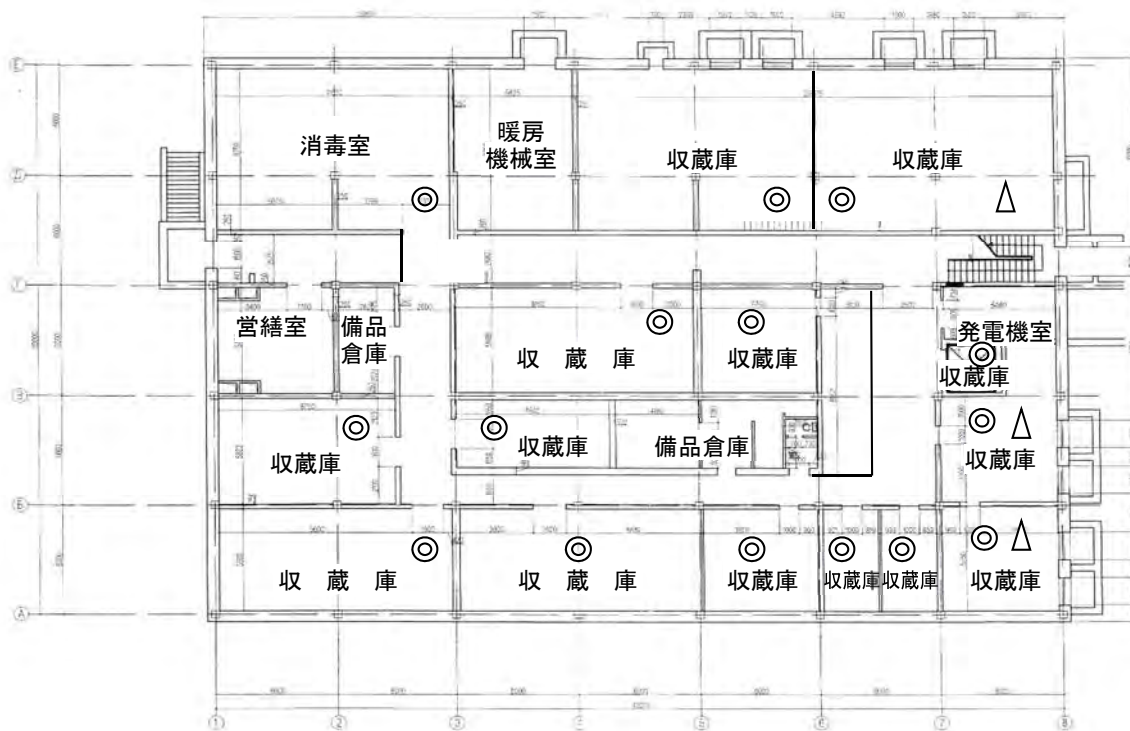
除湿機、加湿器の設置場所：地下 1 階平面図
